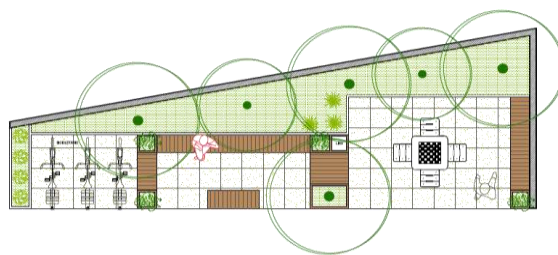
Intervenções do Projeto de Construção e Requalificação de Praças Públicas
